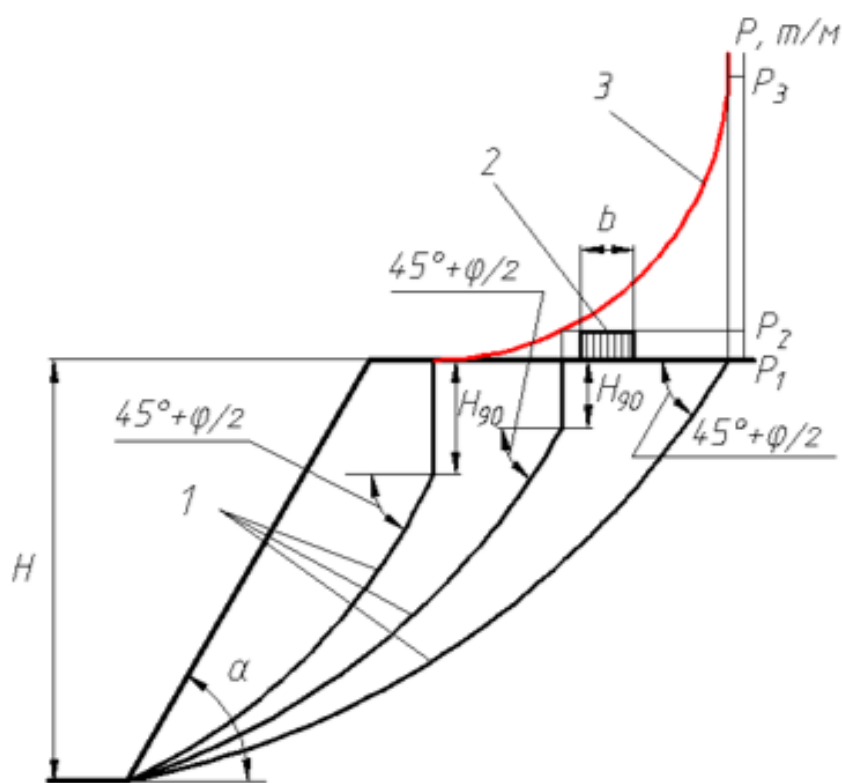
Схема к расчету устойчивости откосов с учетом допустимых статических нагрузок: 1 – расчетные поверхности скольжения; 2 – нагрузка от горного оборудования; 3 – эпюра нагрузки
